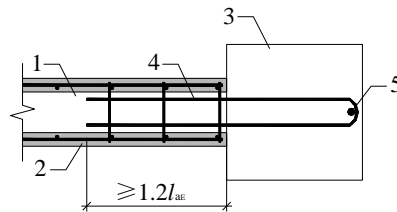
剪力墙端部钢筋搭接构造示意
